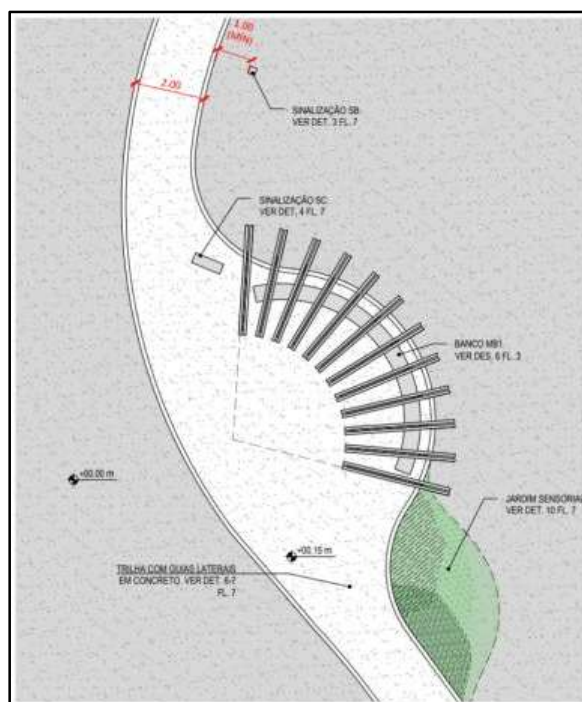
Croqui com planta baixa do conjunto de abrigo único.
